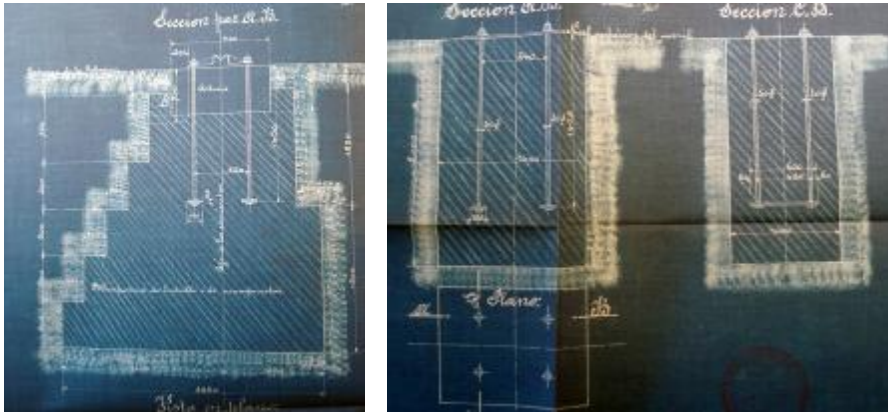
y 255.- Detalles de cimentación. Estación de Valencia. Ferrocarril Central de Aragón. (FFE 2007).
